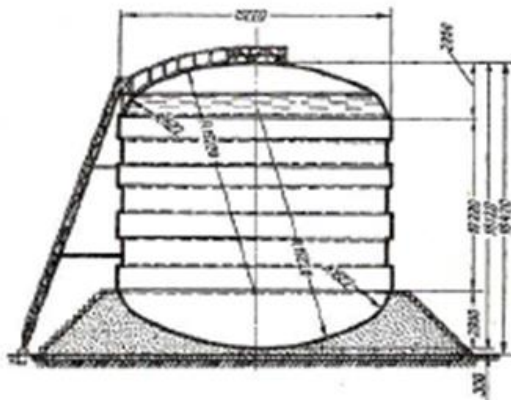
Вертикальний циліндричний резервуар із сферичним дахом і днищем
